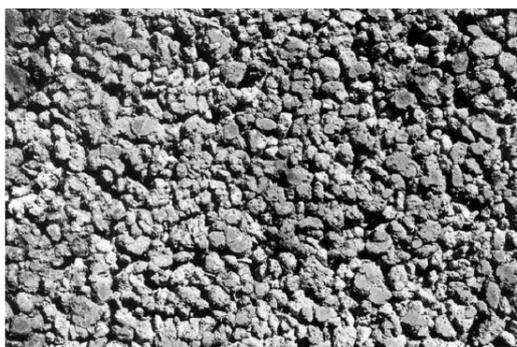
Concreto permeável in loco (fonte: ACI 522-R 13)
